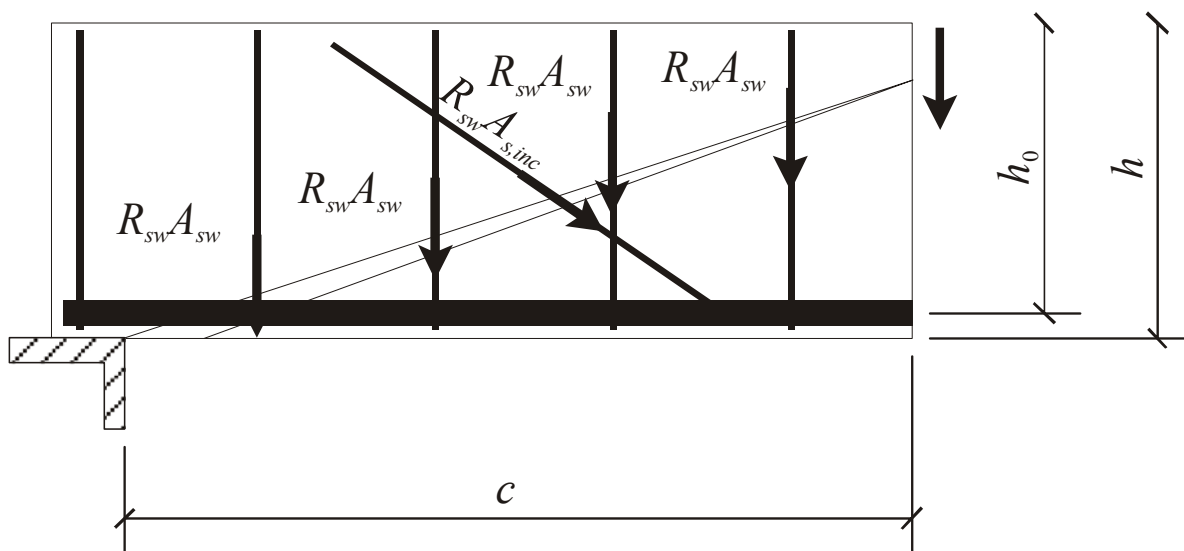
Схема усилий в наклонном сечении железобетонного элемента при расчете его по прочности на действие поперечной силы
